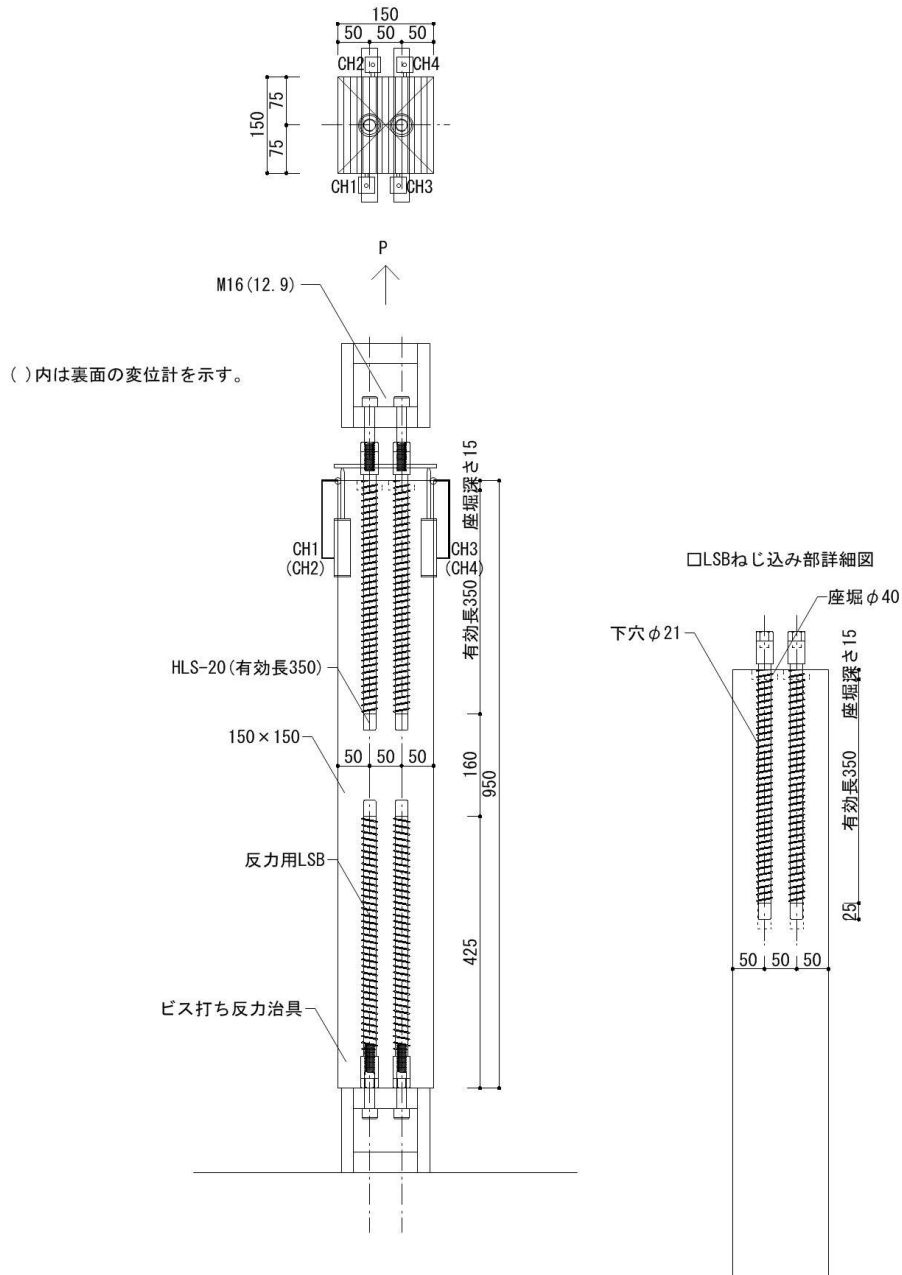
試験体の形状及び寸法 (B-2)
